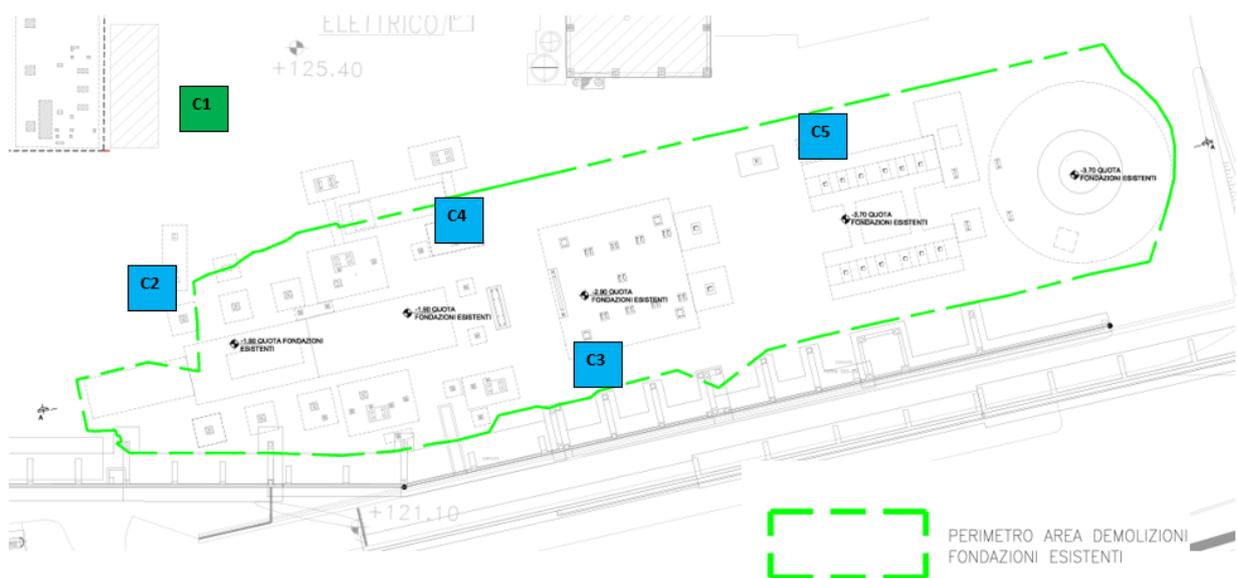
Planimetria ubicazione prelievo campioni
